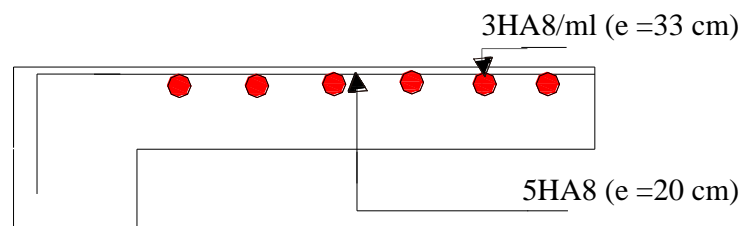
Schéma de ferrailage de la dalle pleine sur un seul appui.
